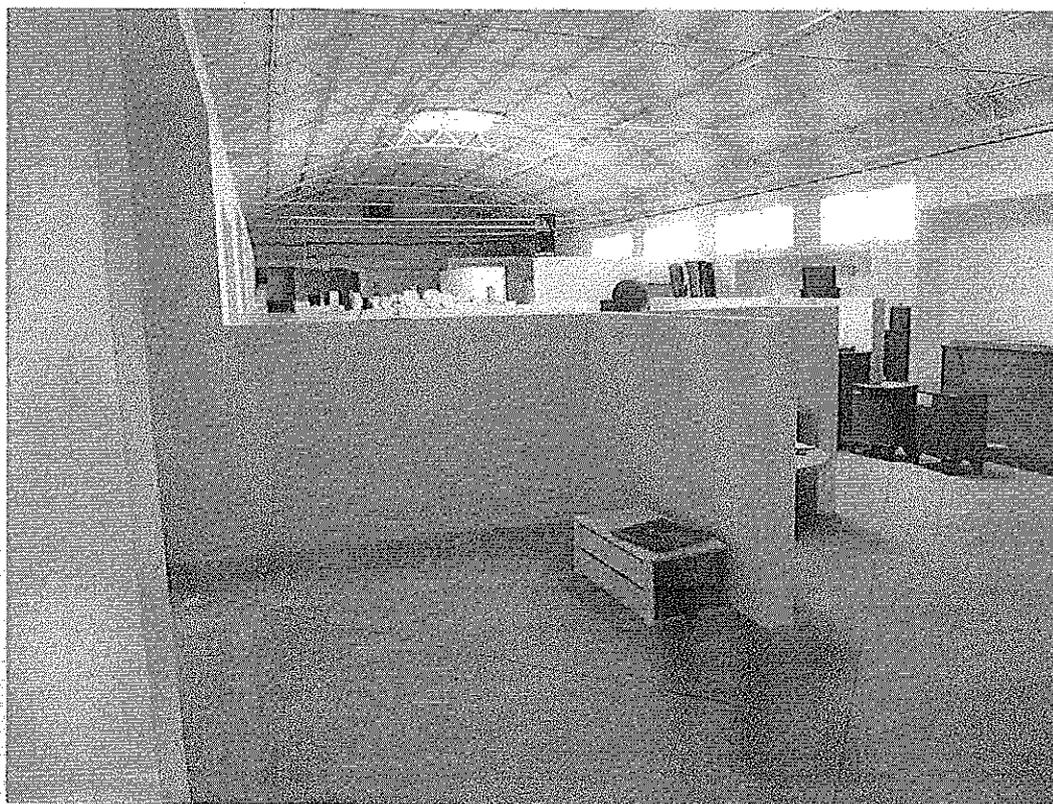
Corpo fabbrica nel fronte Est – vista interna.
